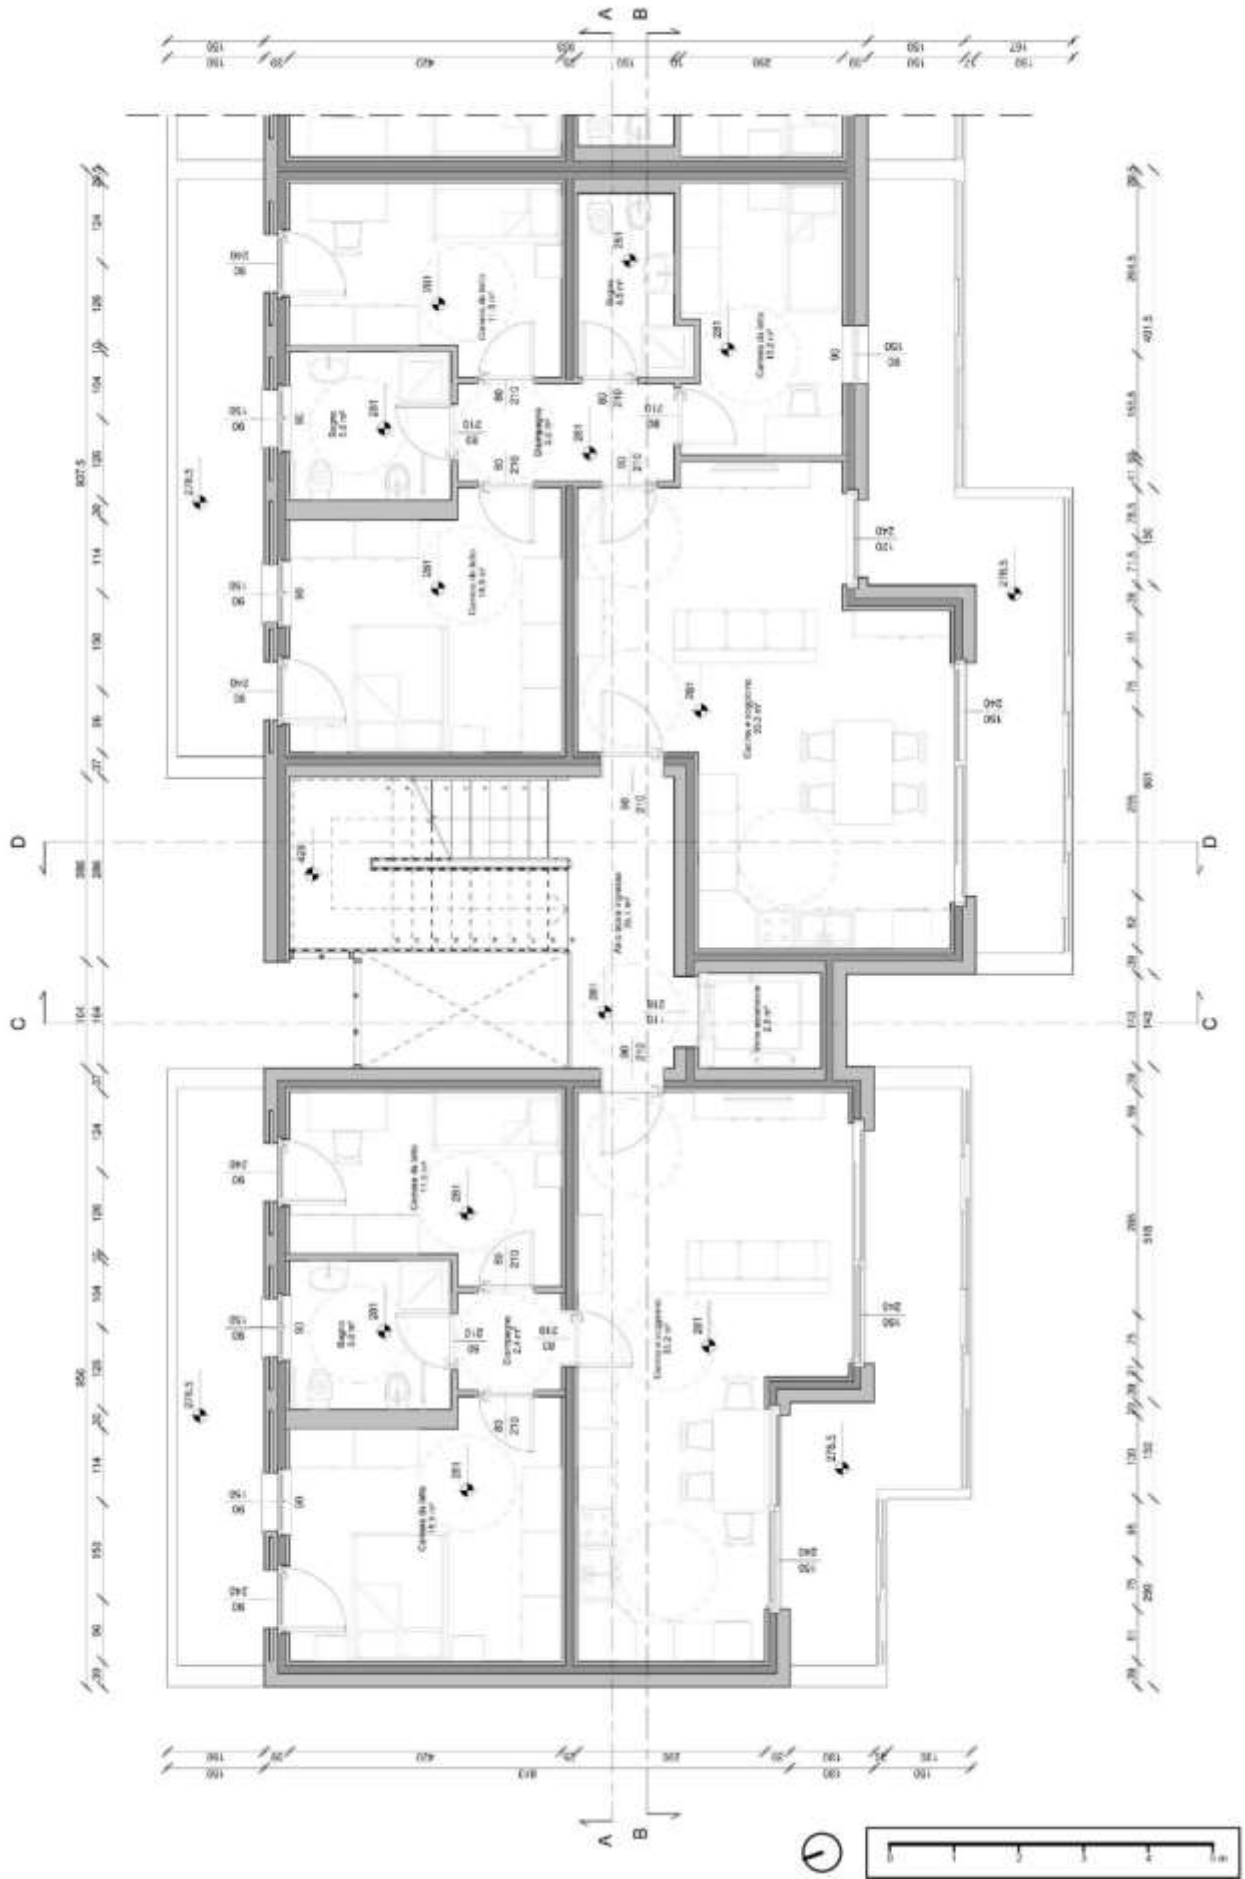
Pianta P01 del Blocco A. [Fonte: elaborazione dell'autore]
